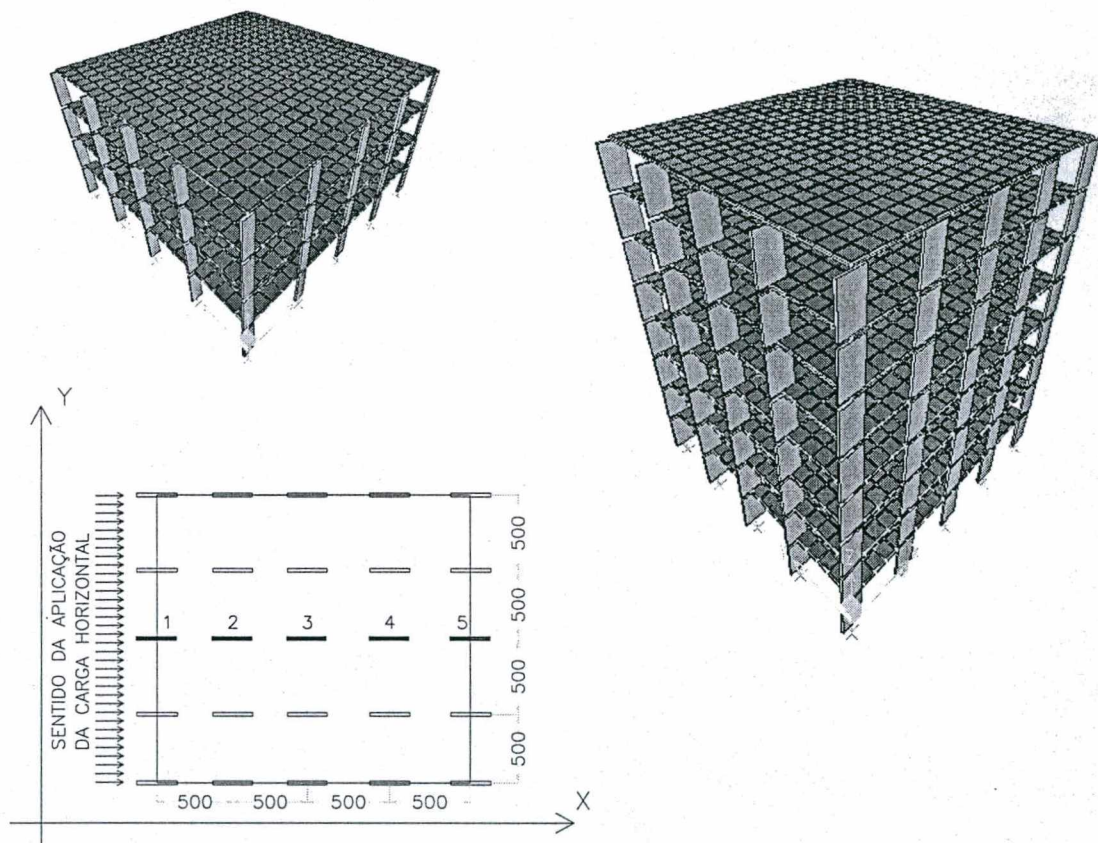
Perspectiva e planta baixa dos edifícios 20x20m com 4 e 8 pavimentos
